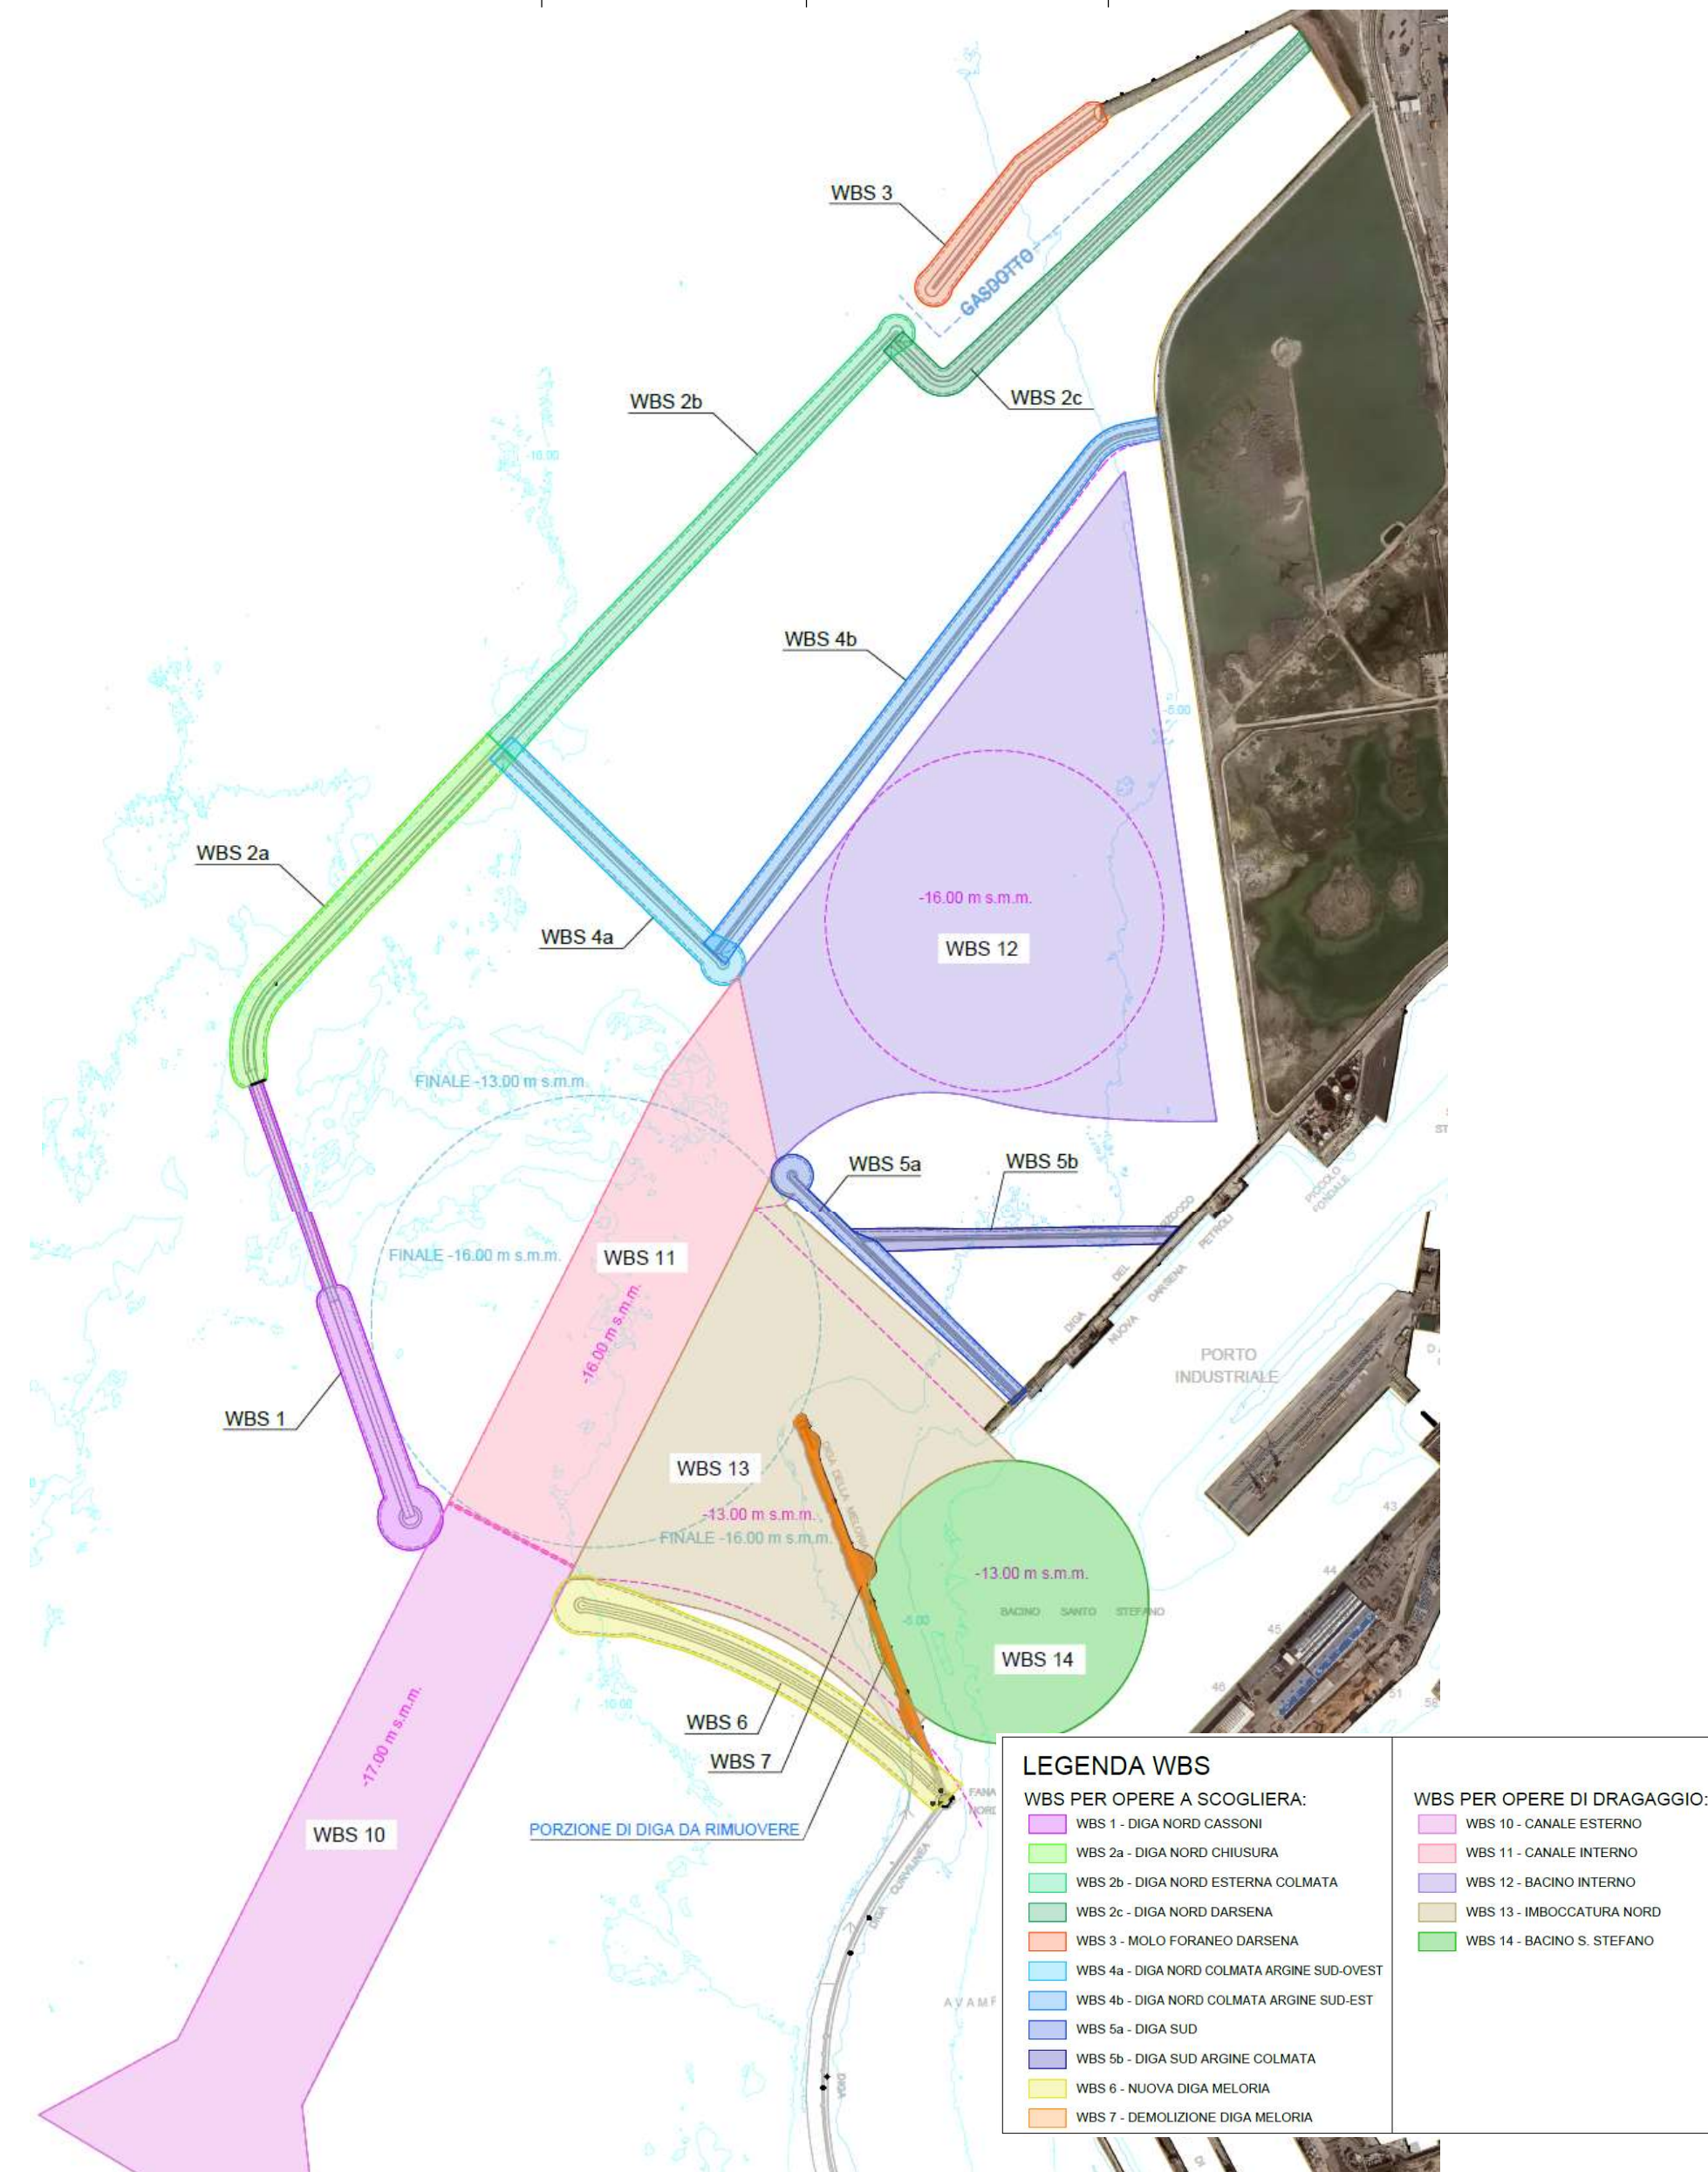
Planimetria delle opere di progetto e delle aree di dragaggio
